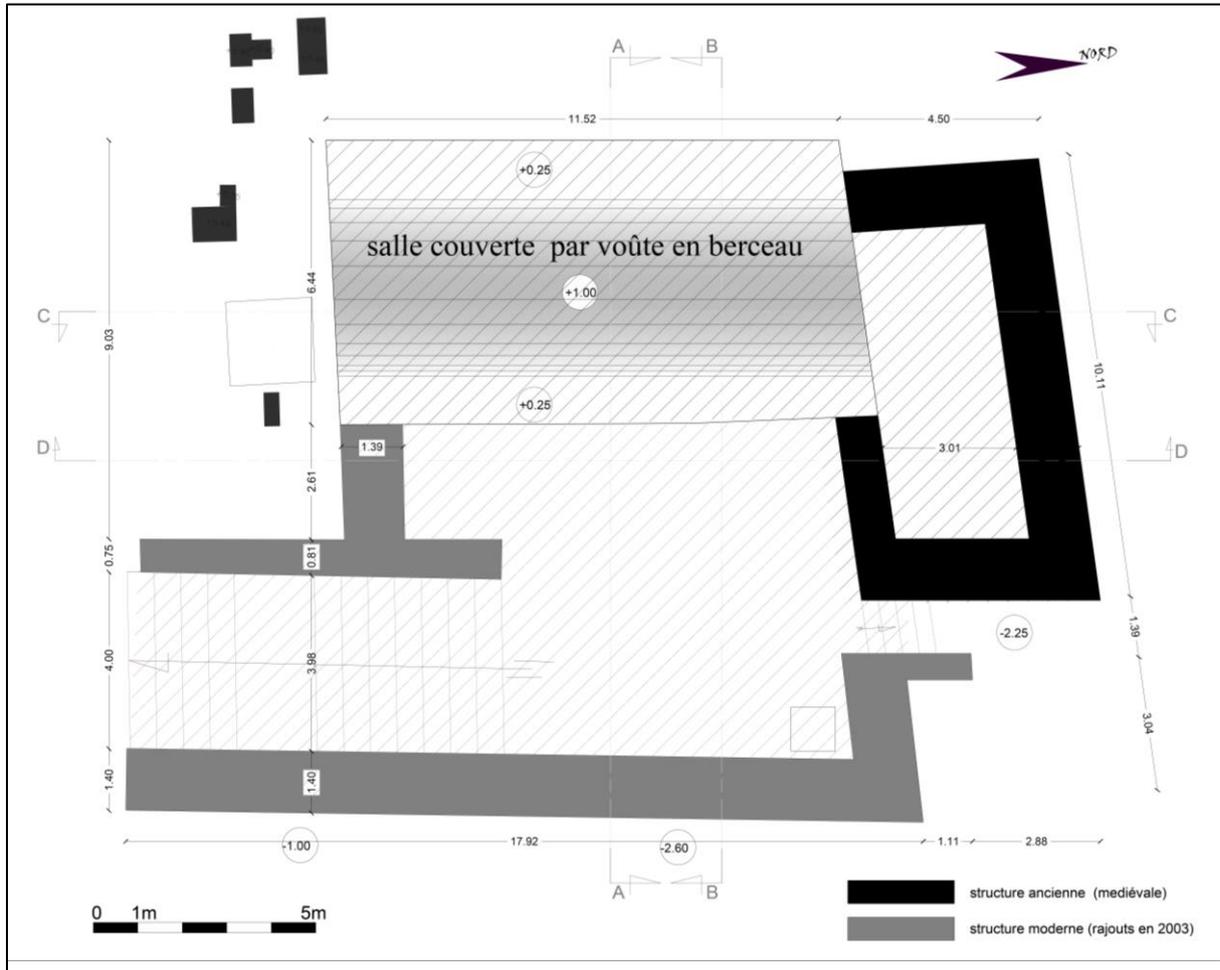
Plan terrasse actuel du bain d'Agadir sur format DWG. Source auteur
